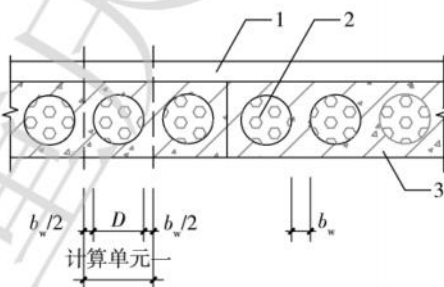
预应力混凝土空心楼盖截面示意图及计算单元示意图
